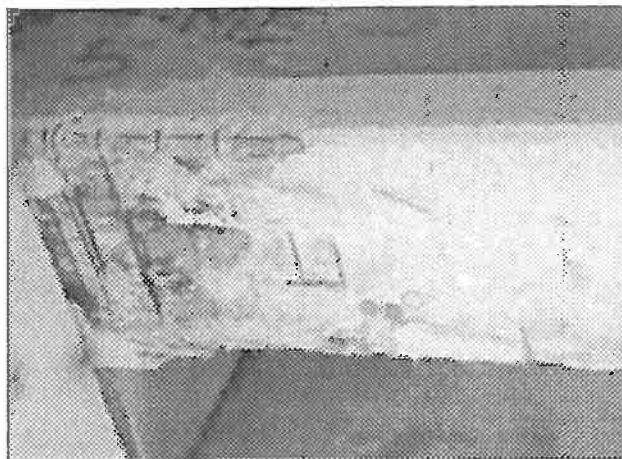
Corner spalling e esposizione diretta delle armature alla fiamma nell'intradosso della trave.
